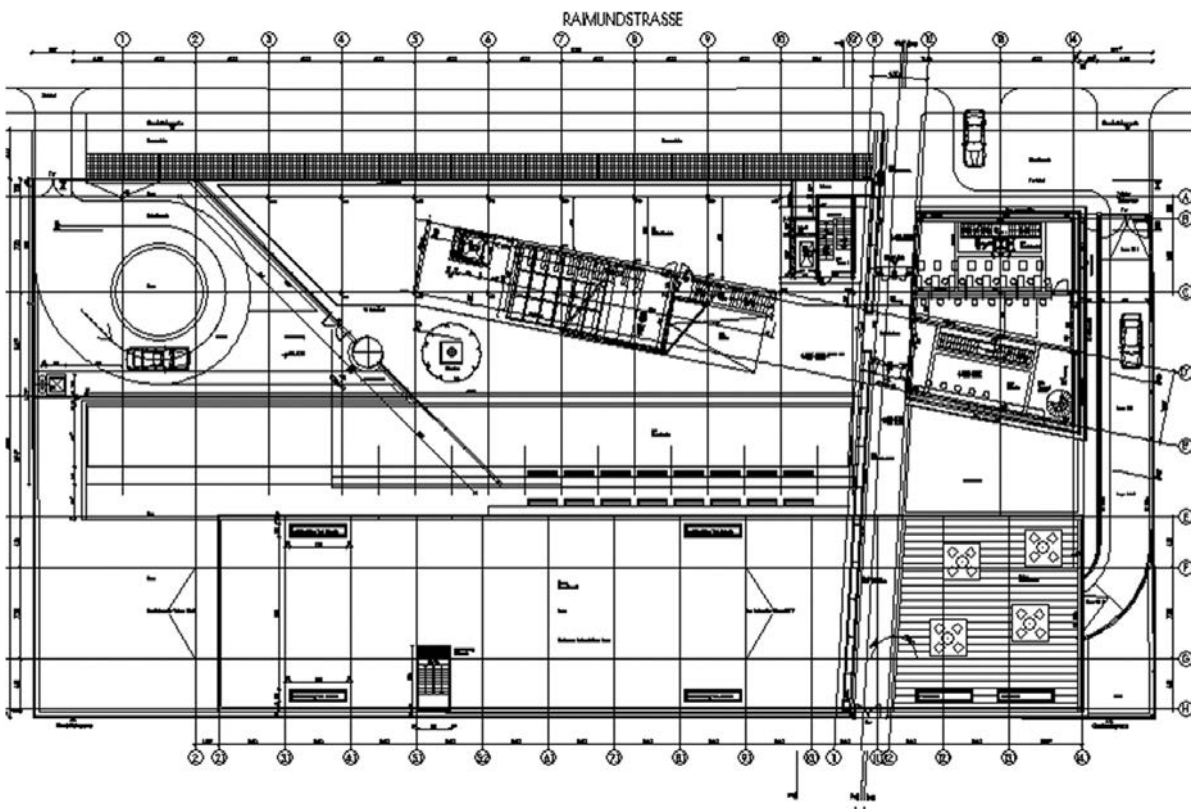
Planta baja. Cortesía de despacho Möller, Bad Nauheim.
